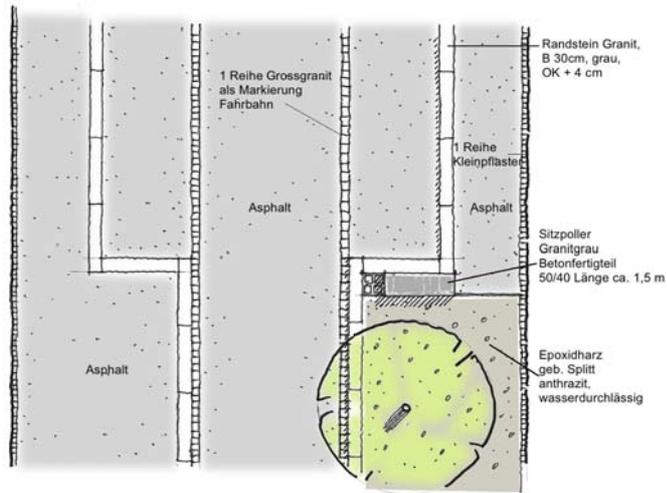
Detail Beläge in Standardstraßen mit Parkierungsschwerpunkt
